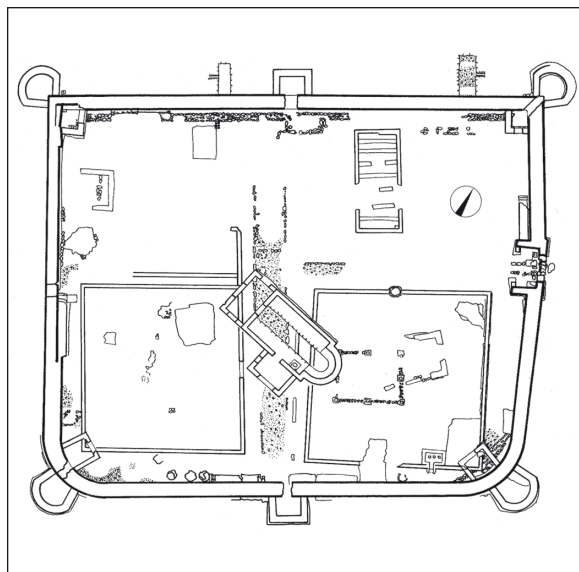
Boljetin. Grundriss (Kondić 1984, Abb. 11).
